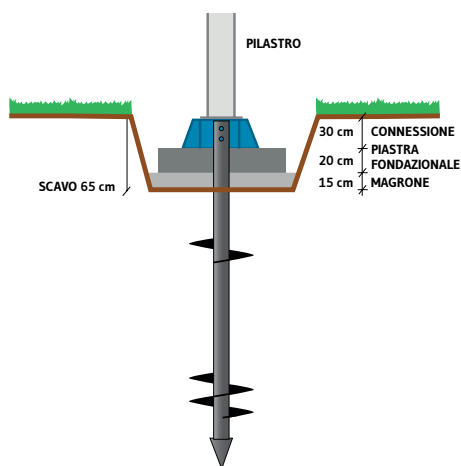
Schema tipo della fondazione mista plinto-palo Geosmart.
